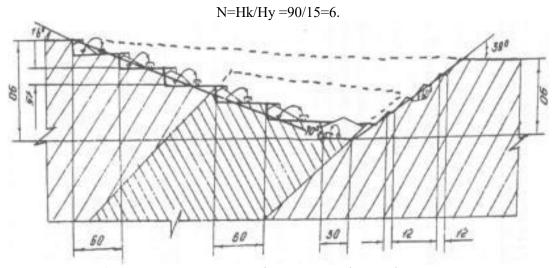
Схема конструкций рабочего и нерабочего бортов карьера
